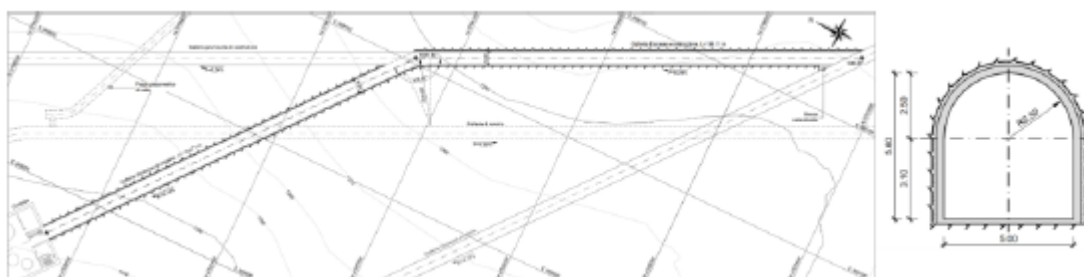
Galleria di accesso alla nuova centrale in caverna – pianta e sezione tipo
